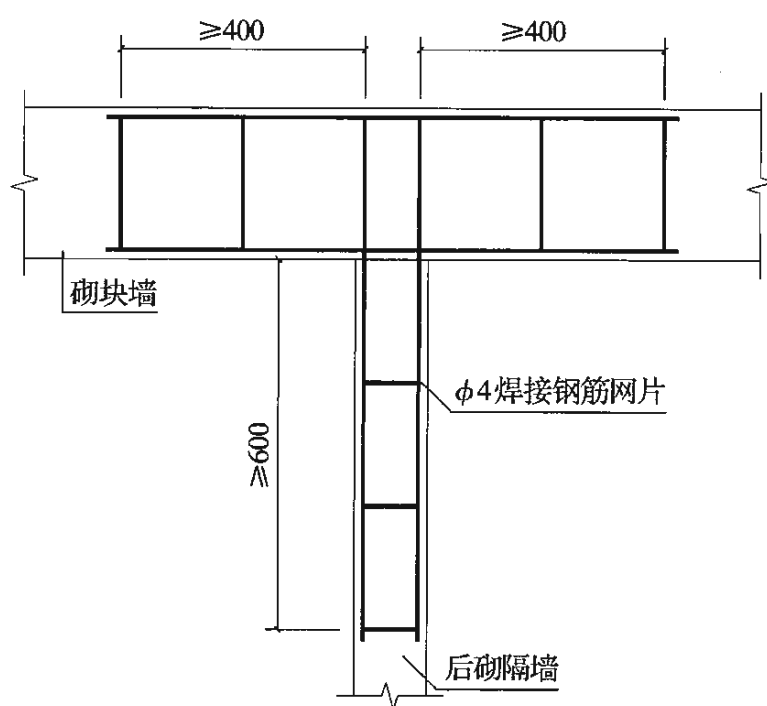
砌块墙与后砌隔墙交接处钢筋网片
